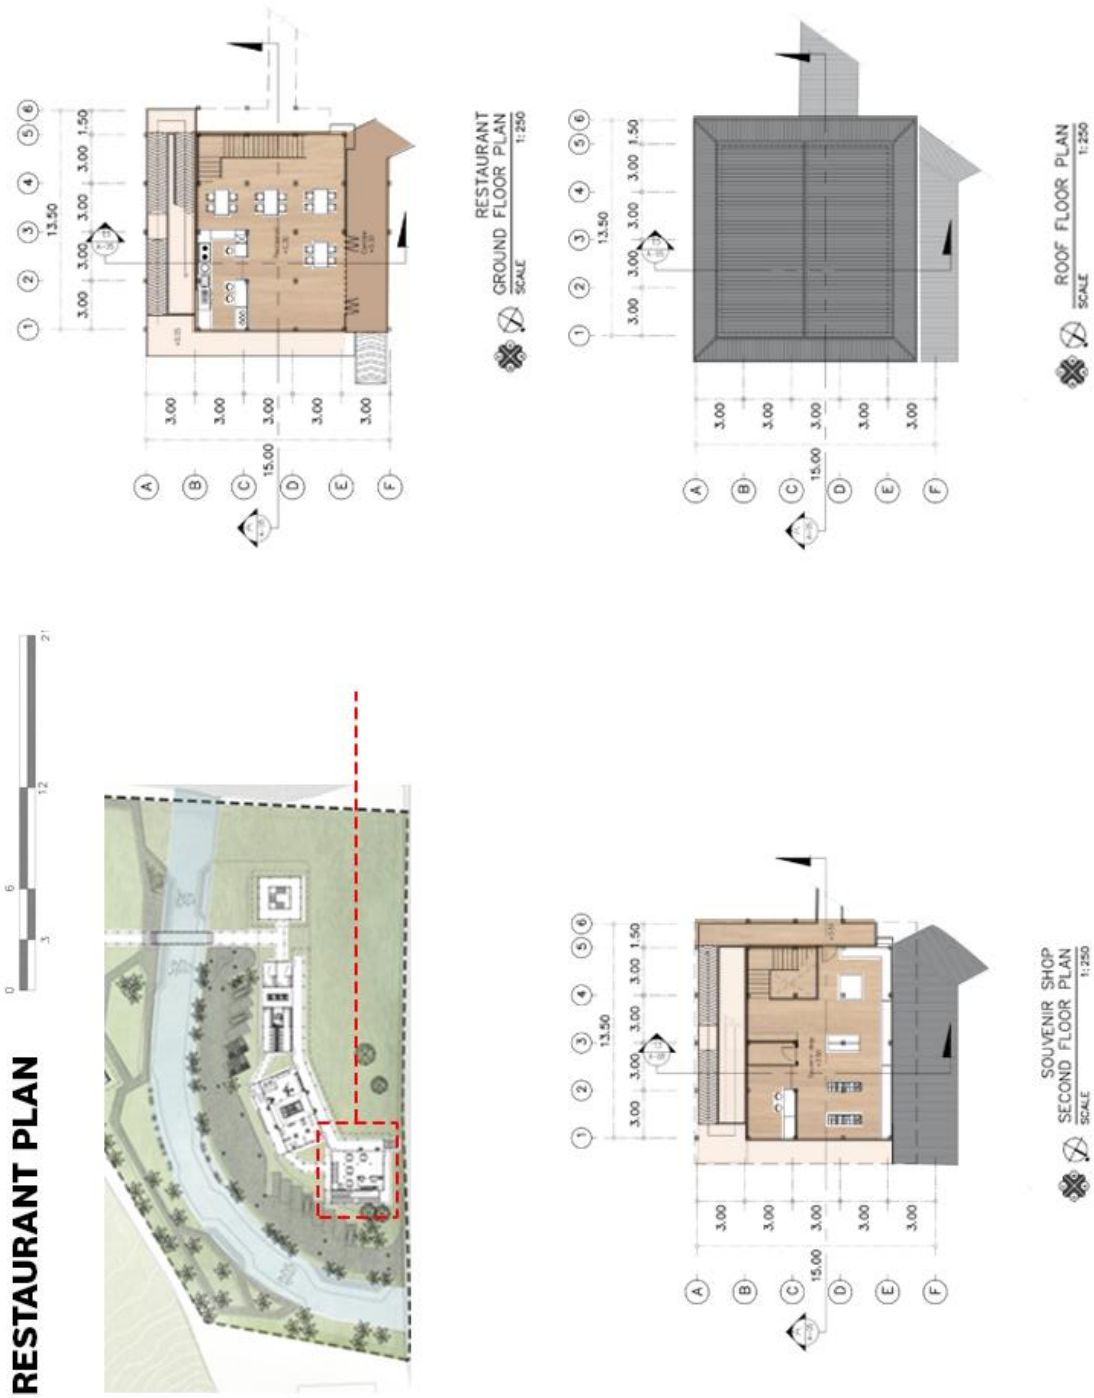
SECOND FLOOR PLAN SITE 01
